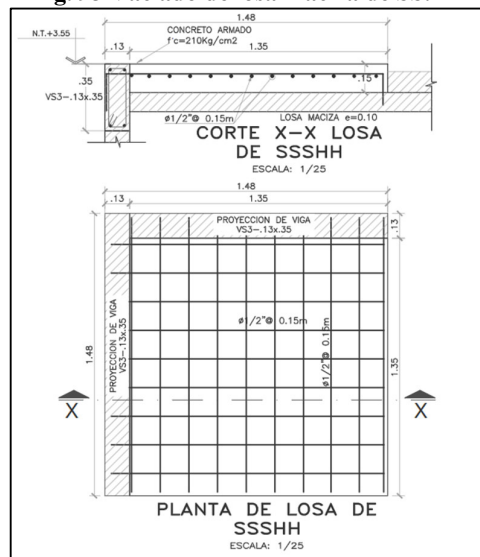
Extracto de detalle de losa maciza del plano de estructuras
